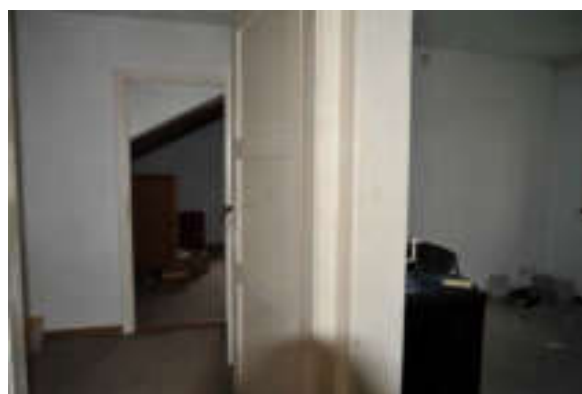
Östlicher Gebäudeteil, Obergeschoss, Blick vom Korridor/Treppenhaus 101 nach Osten. Rechts Zimmer 102, links Zimmer 103 und geradeaus das Dachzimmer im versetzten Anbau.
